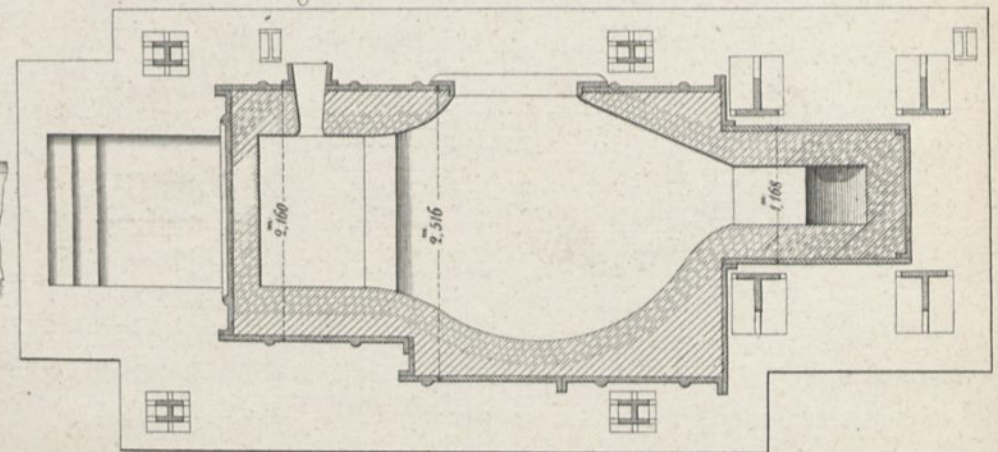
Grundriss und Schnitt nach B-B des Aufzuges.
